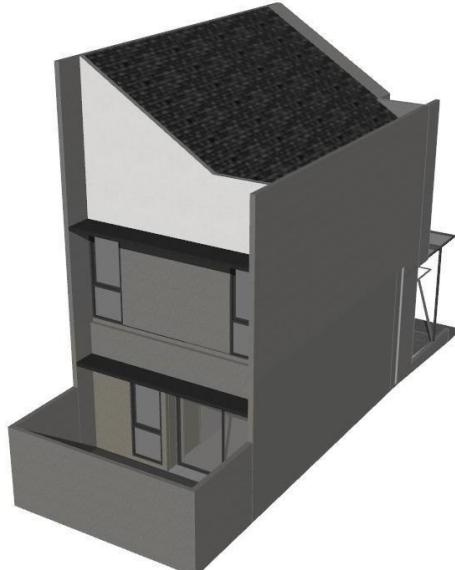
Potongan Tipe Bangunan 5x13 Sudut
